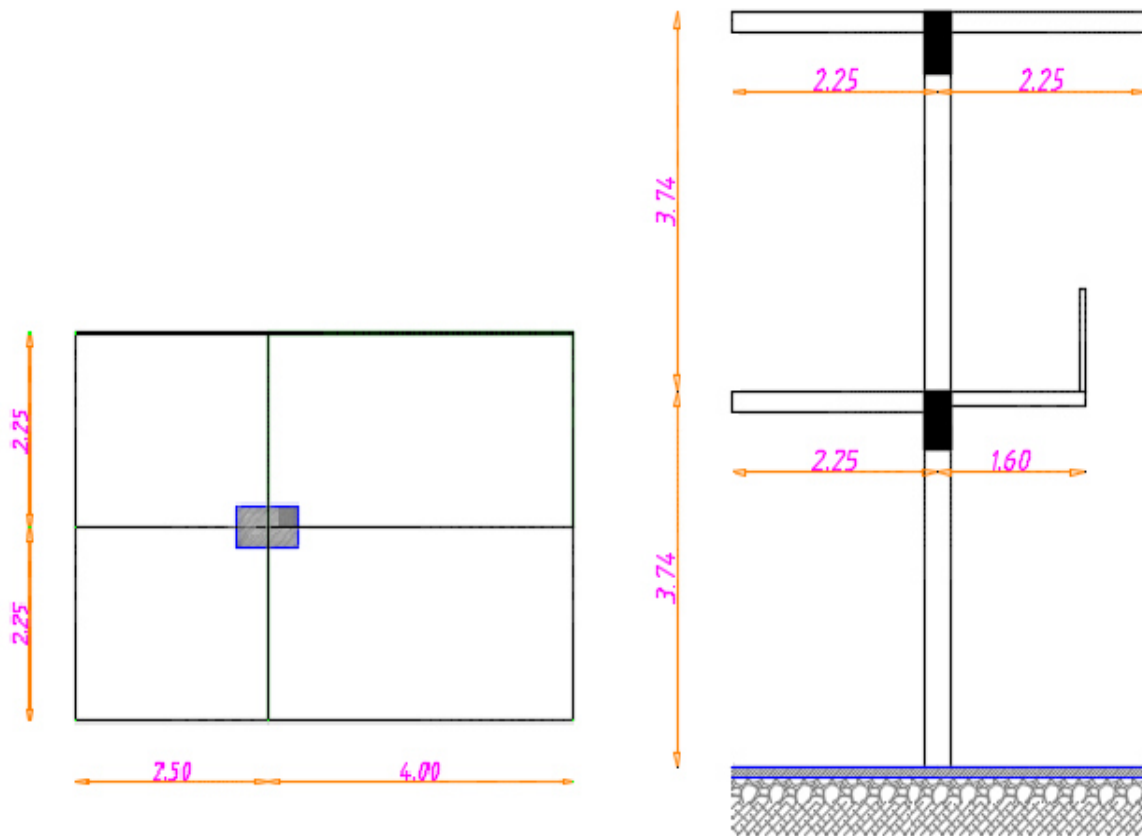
schéma de poteau Intermédiaire bloc B.
